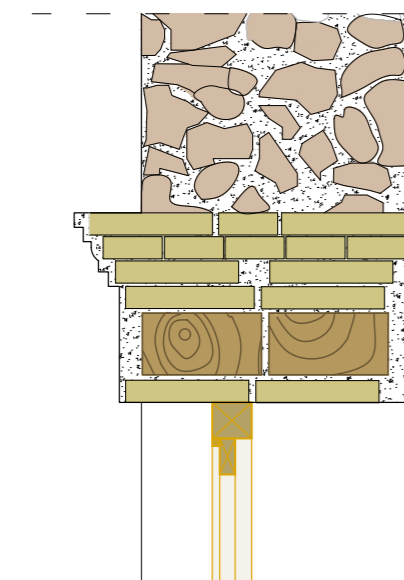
(Arriba) Vista de zona de zócalo del muro de mampostería.
